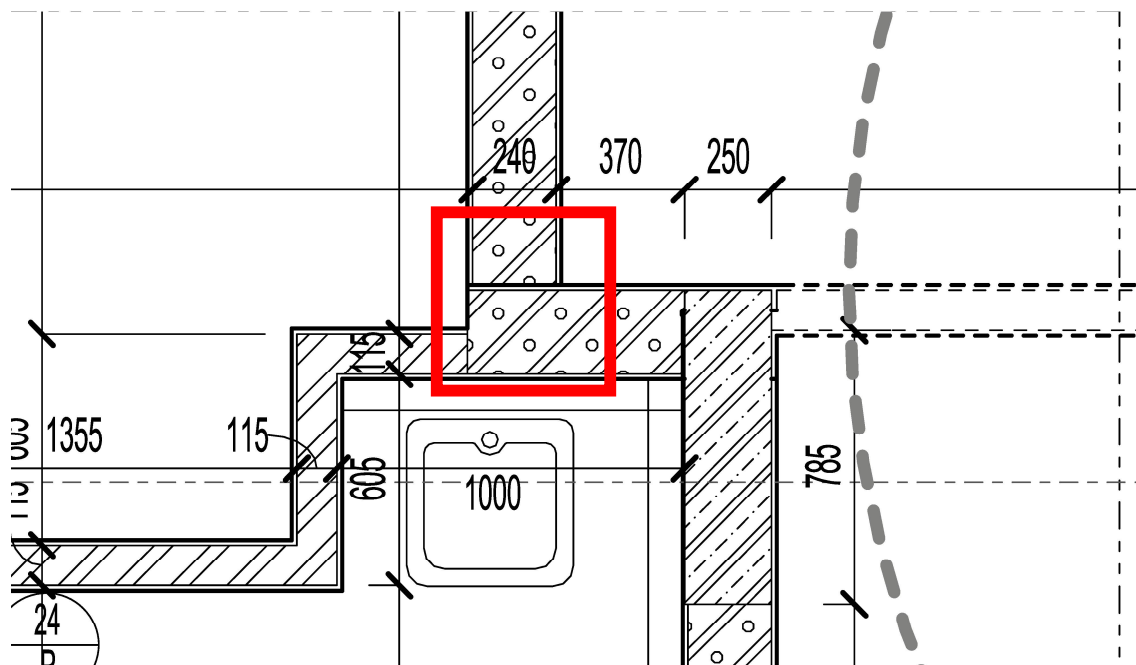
Půdorys 1NP (výřez 1) – objekt A34
